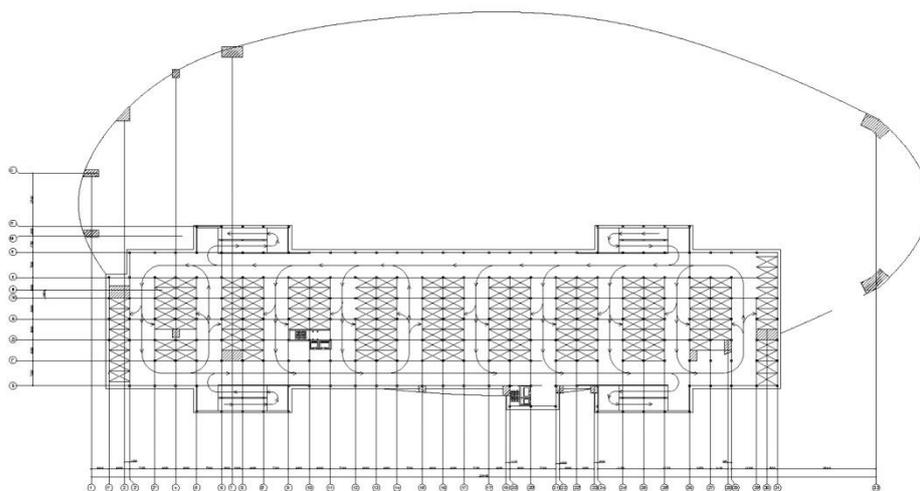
План подземного паркинга (-2 этаж) на отметке -10.500
